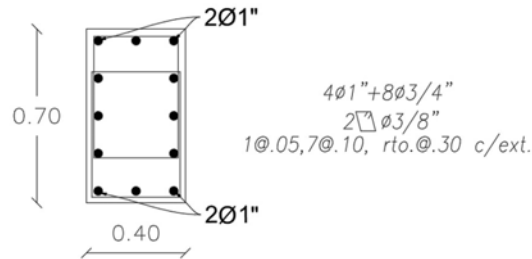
Armado de acero de la columna C-1 del 1° al 3° piso
